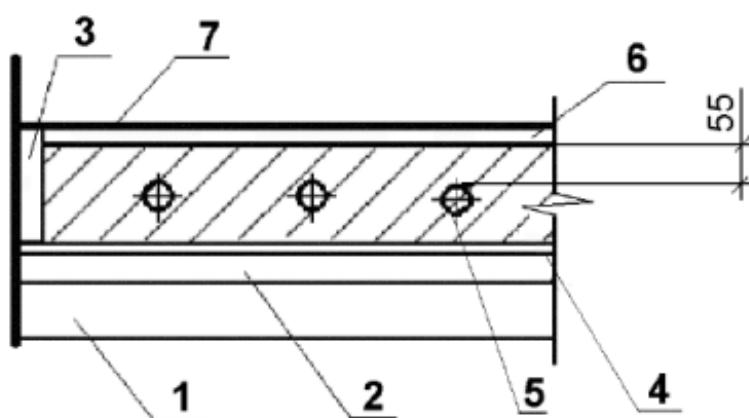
Пирог системы «тёплый пол»: 1 – перекрытие; 2 – тепловая изоляция; 3 – усадочный шов; 4 – гидроизоляция; 5 – греющий контур; 6 – стяжка из цементно-песчаного раствора; 7 – напольное покрытие
